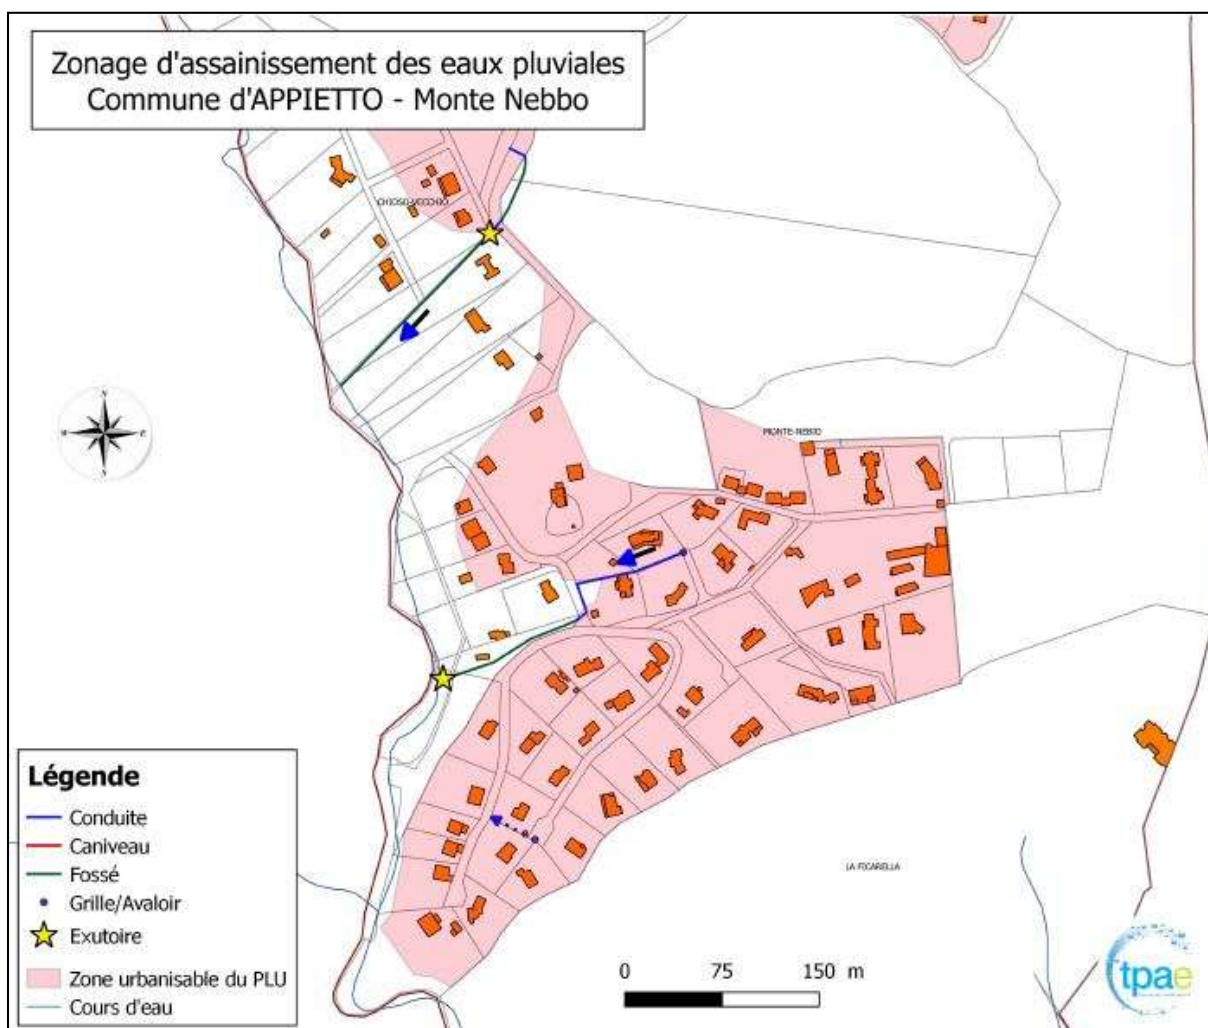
Plan du réseau pluvial du hameau Monte Nebbio
